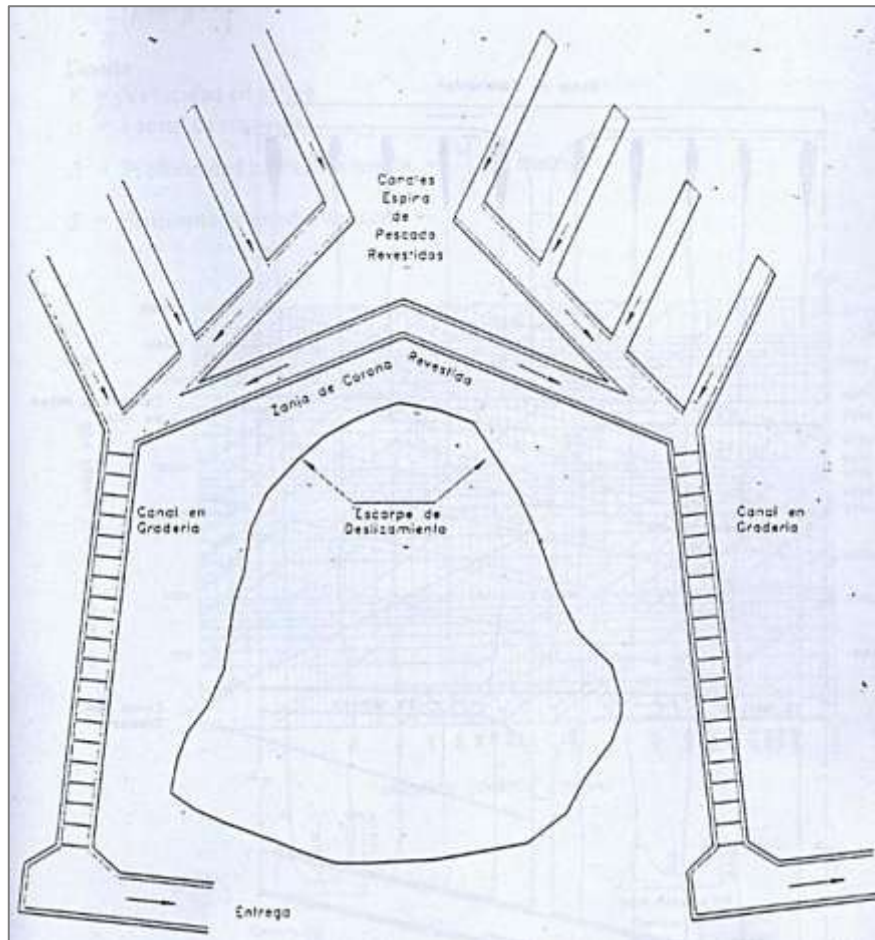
Esquema de planta de canales colectores espina de pescado con canales en gradería
